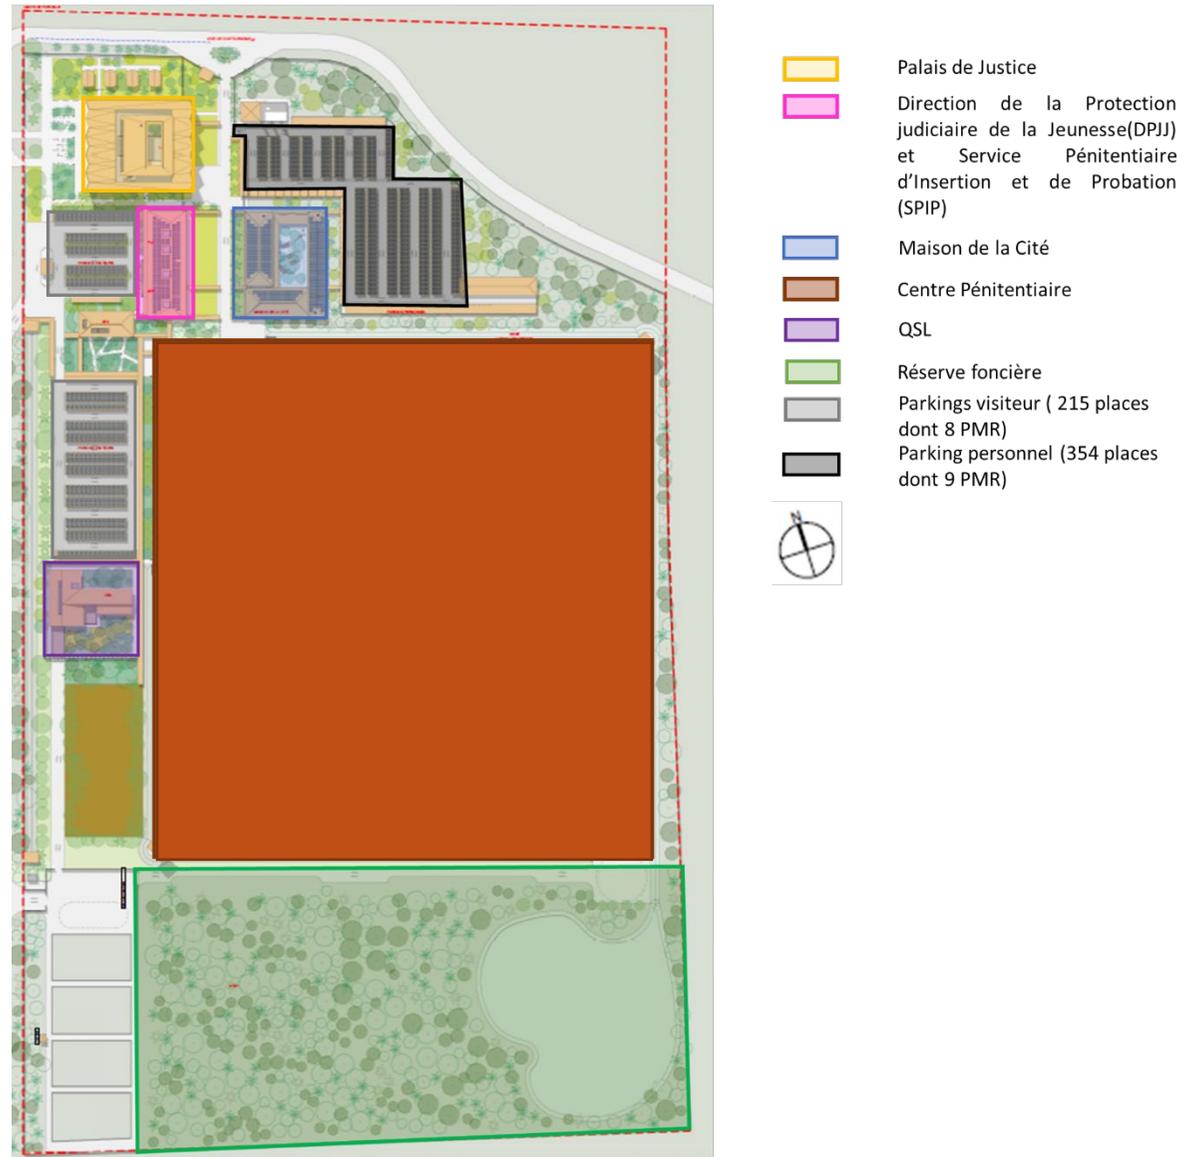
Plan masse de la cité (Source : Architecturestudio, Actierra 2024)
